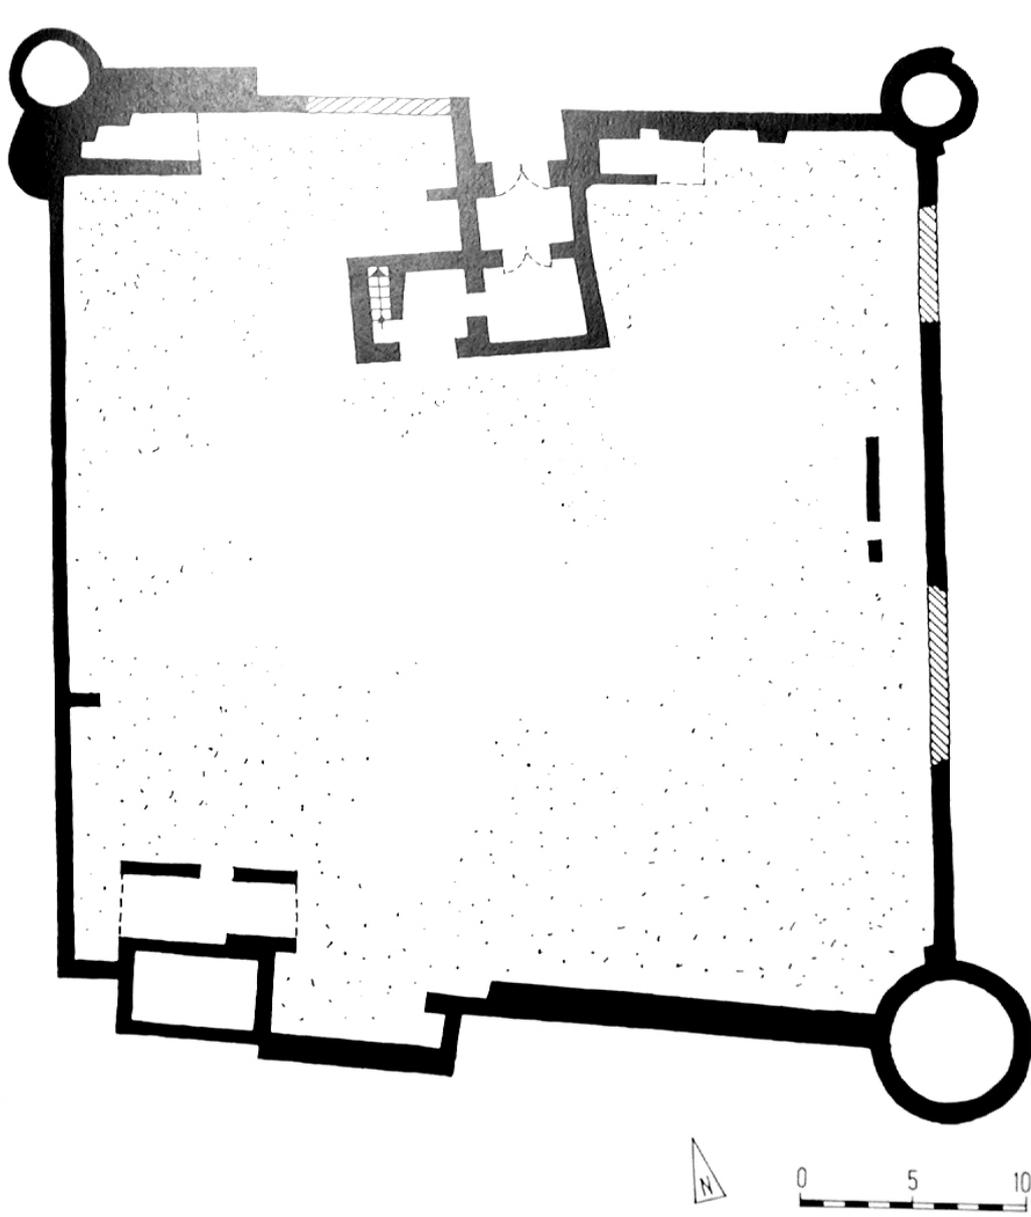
Der Grundriss einer sur oder Wehrburg
